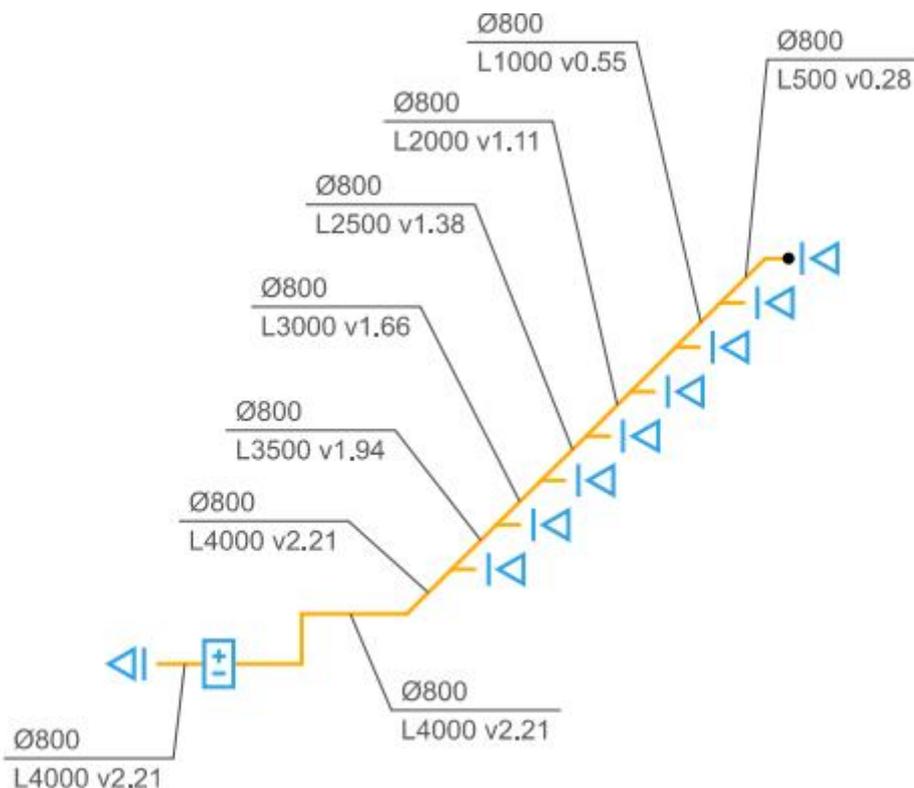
Фрагмент схеми вентиляції ПВ-1(витяжка) для аеродинамічного розрахунку
